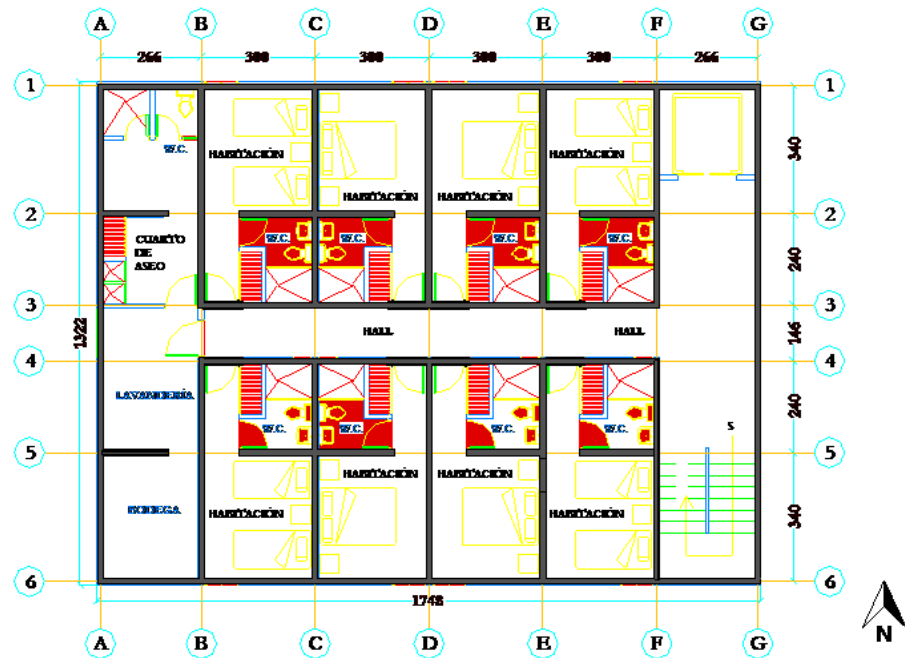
Planta Arquitectónica Hotel Modular: Caso Estudio #1
